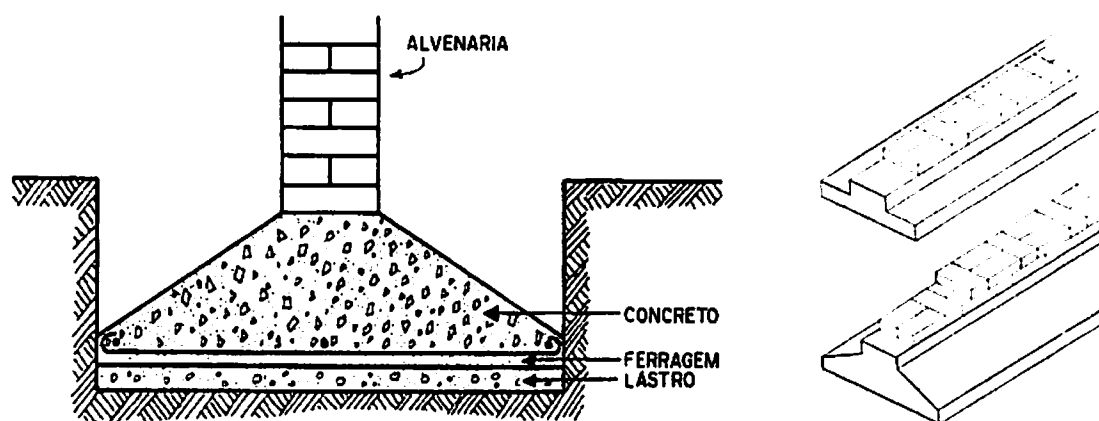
Sapata Corrida (viga de fundação ou baldrame)
